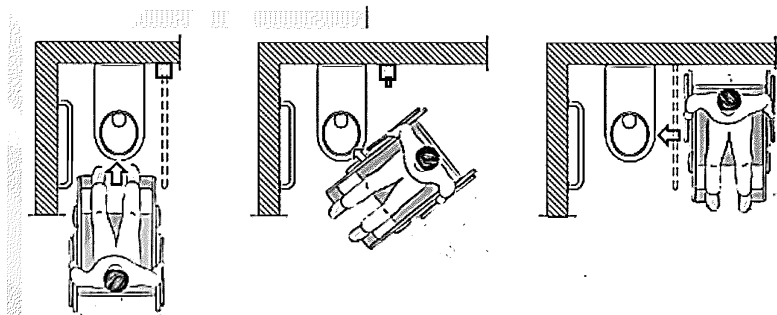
Способы пересадки с кресла-коляски на унитаз
